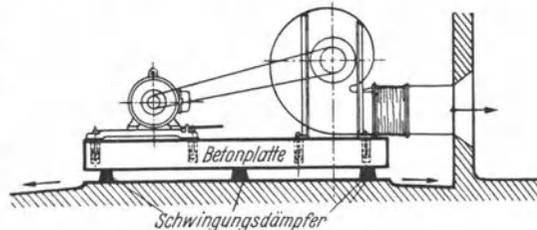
Lüfter mit Antriebsmotor auf gemeinsamer, gegen den Boden zu abgedämmter Grundplatte.
